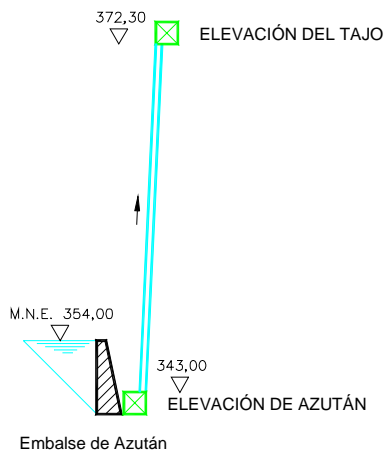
Conducción Azután-Aldeanueva. Esquema en alzado
